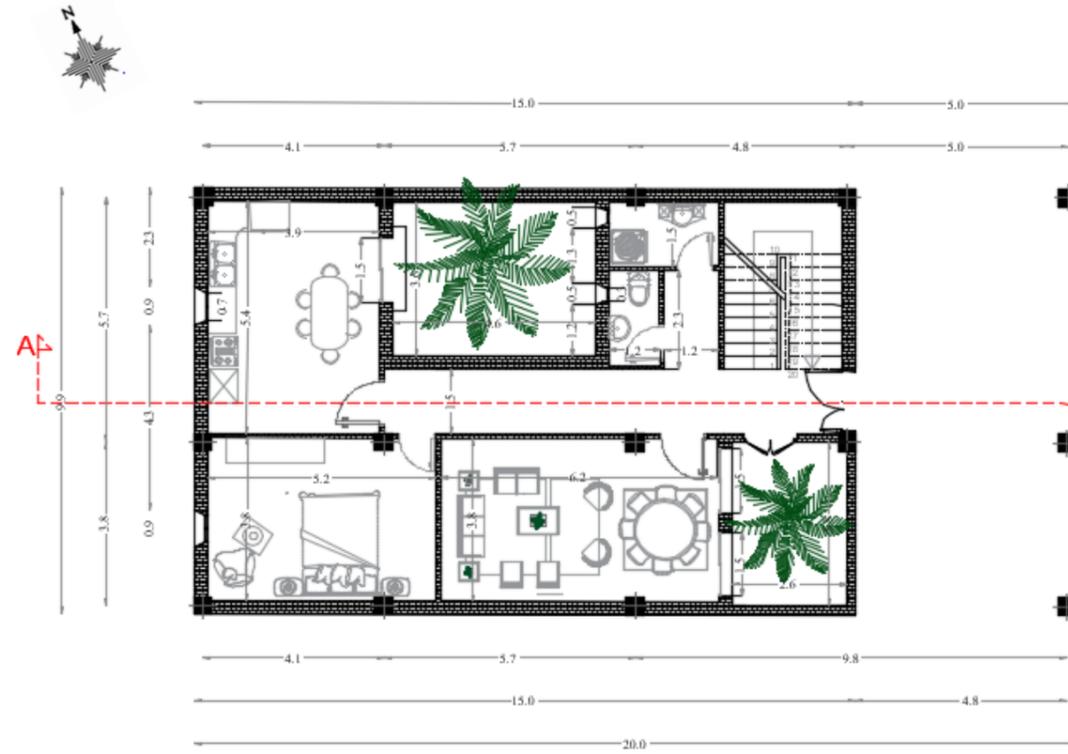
PLAN RDC LOGEMENT TYPE2;
